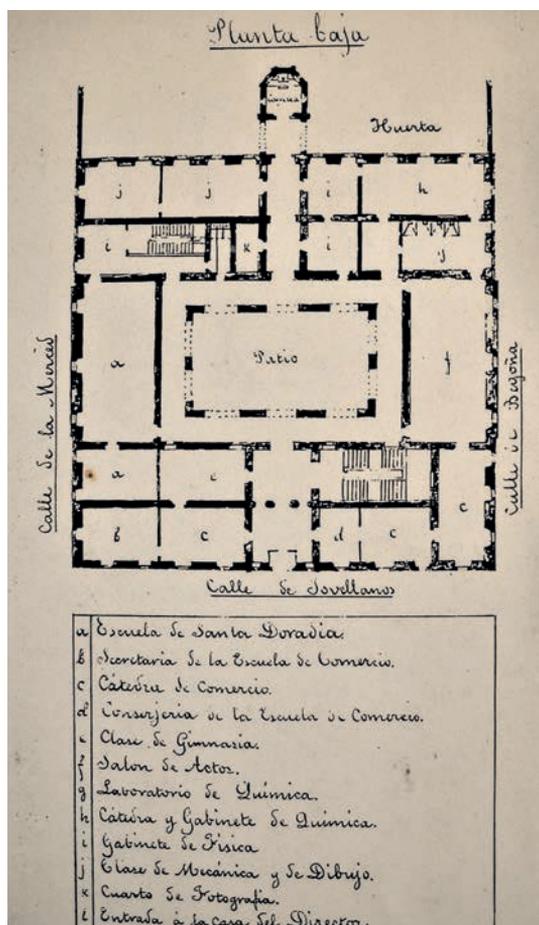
El Gimnasio se encontraba enfrente a las escaleras en la planta baja, entrando a la izquierda.
